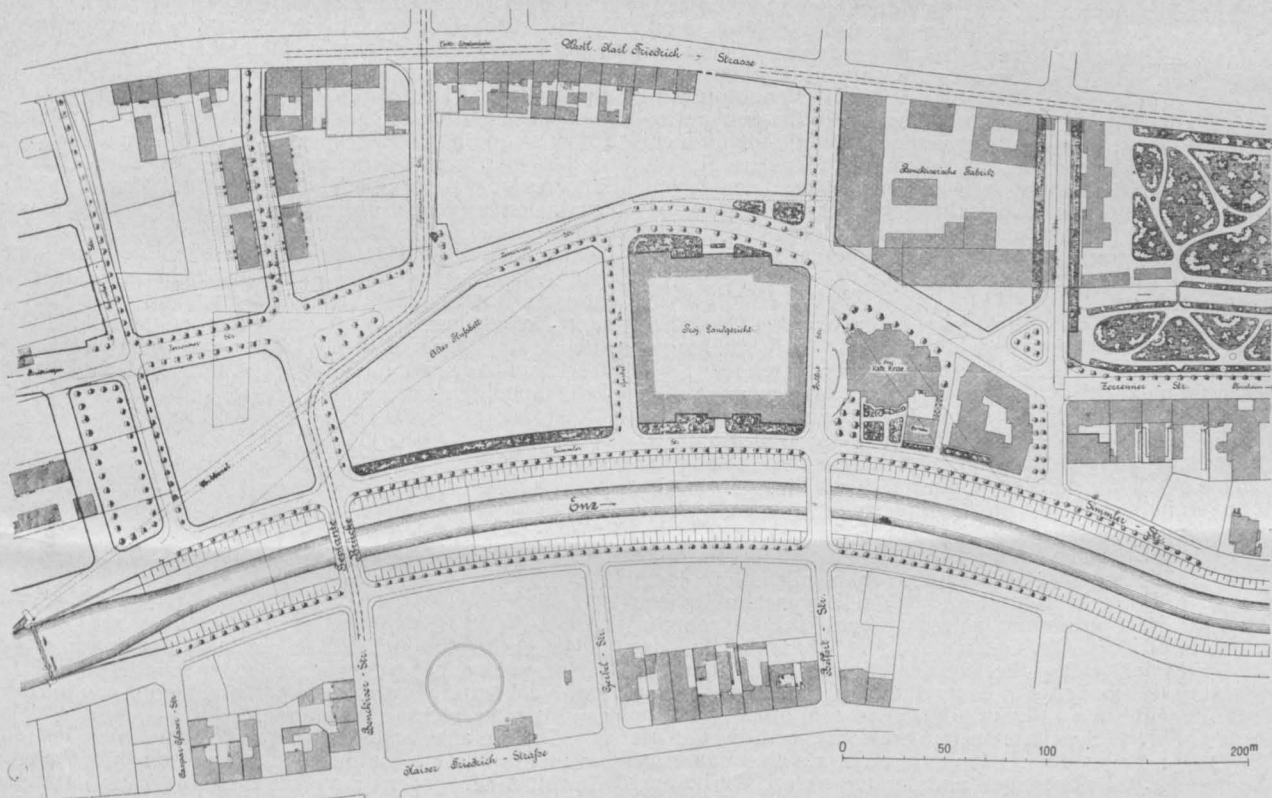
Lageplan für die Umgebung der geplanten neuen Brücke im Zuge der Benckiser Straße.
